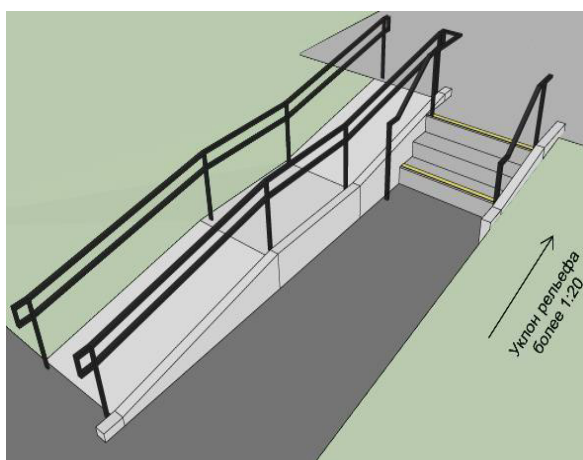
Совмещение пандуса и лестницы на уклоне
